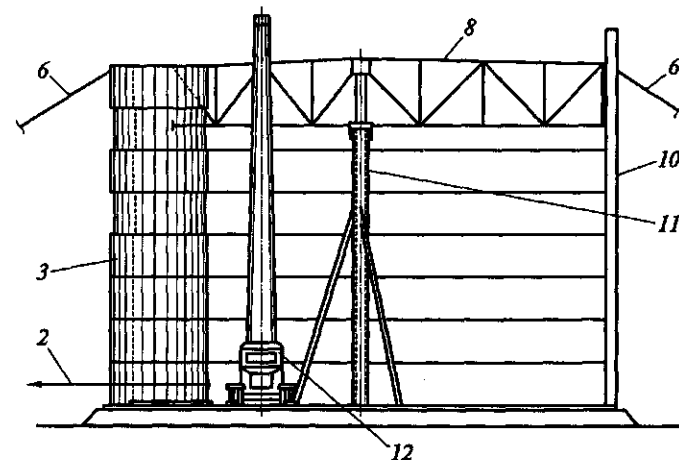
Монтаж резервуара из рулонных заготовок:
